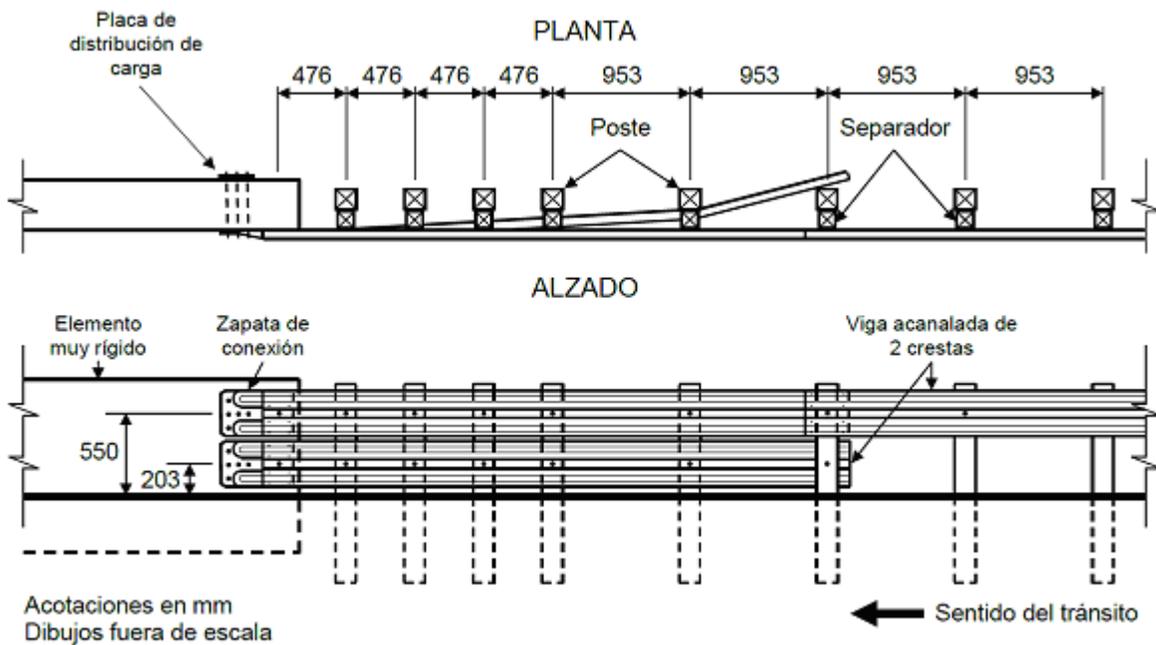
Transición de barrera metálica de doble banda a muro vertical recto
